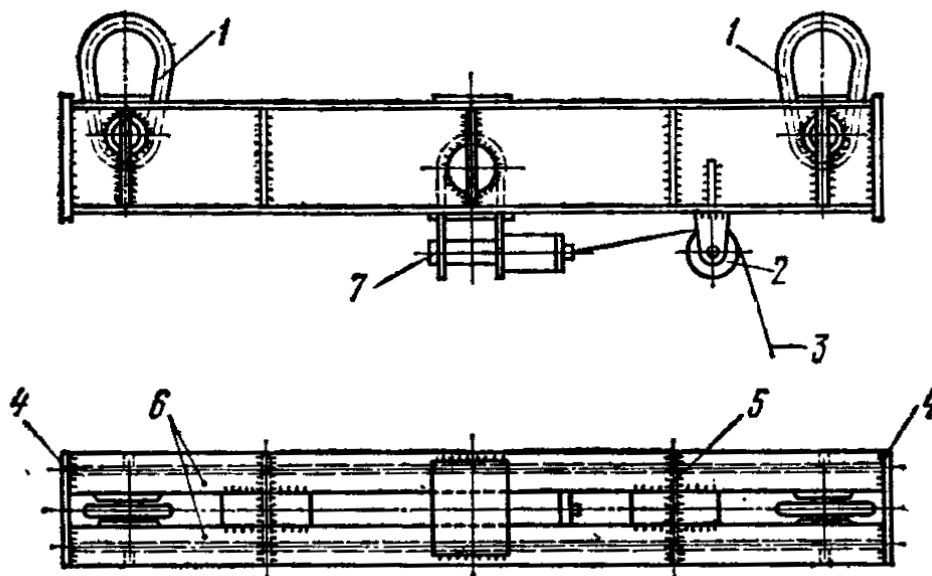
Балансирна рівноплечова траверса: 1 – підвіска; 2 – відвідний блок; 3 – трос для розстропування; 4 – листові накладки; 5 – розпорки; 6 – двотаври; 7 – напівавтоматичний захват
